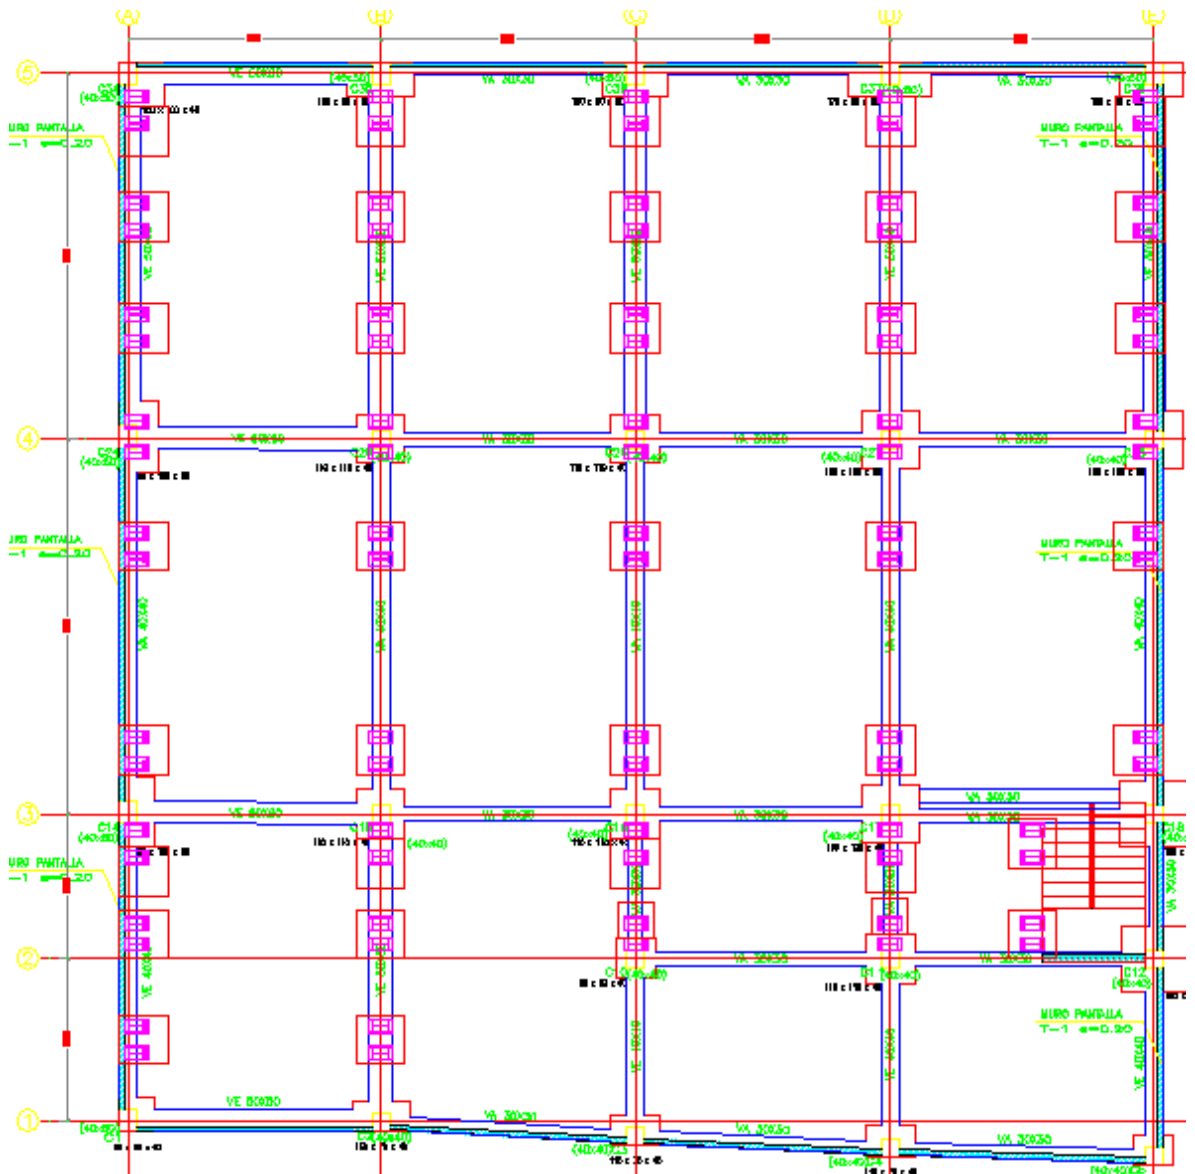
Plano estructural– vista en planta de cimentación nivel - 3.60
